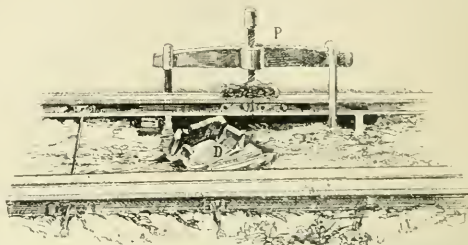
Joint de deux rails en préparation pour la soudure.
